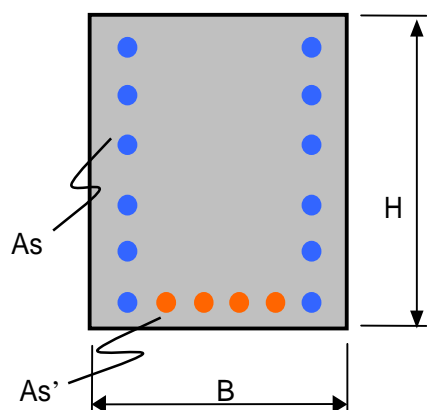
ひび割れ発生方向と抵抗鉄筋概要図
